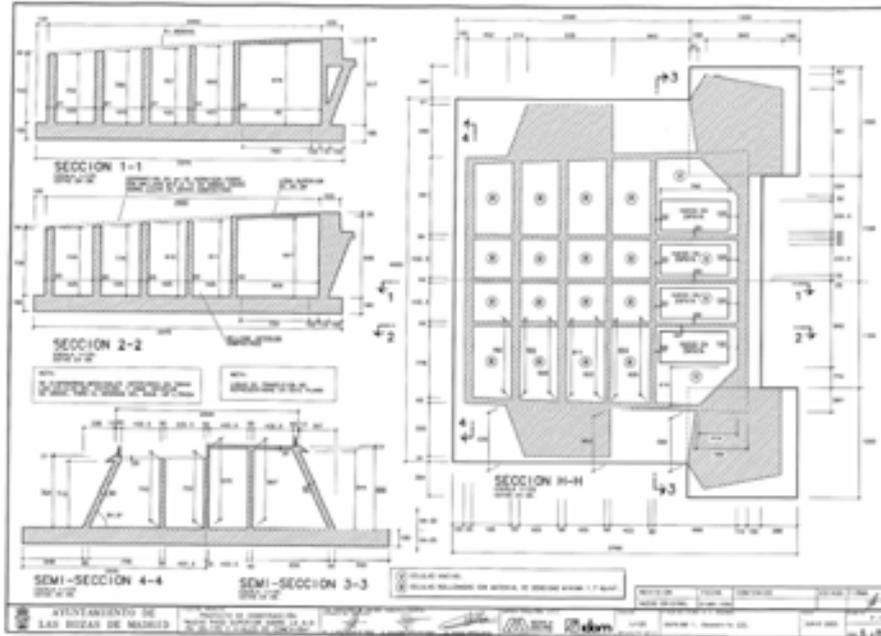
Plano de configuración del estribo contrapeso con células rellenas de terreno
